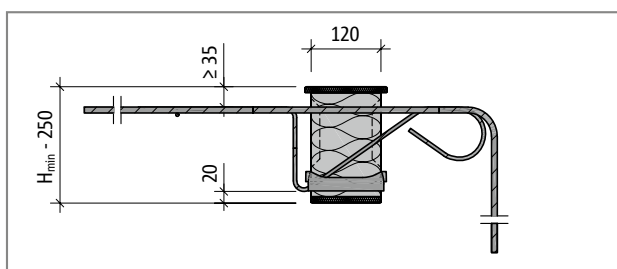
Schöck Isokorb® XT typ KL-BH: Řez prvkem
